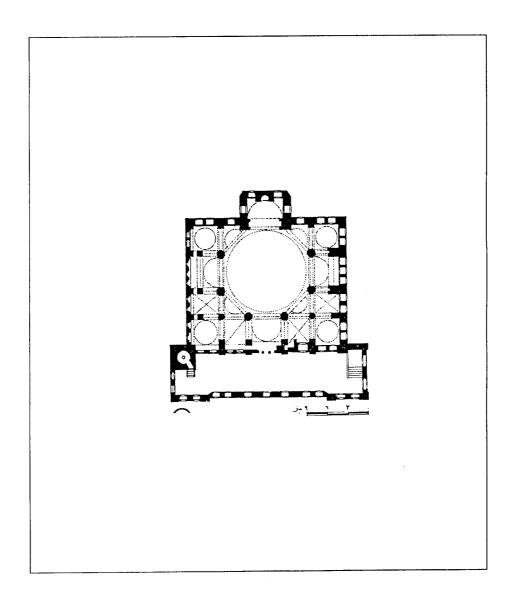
مسقط أفقي لمسجد بيالي باشا في إستانبول (عن : جابرييل)
